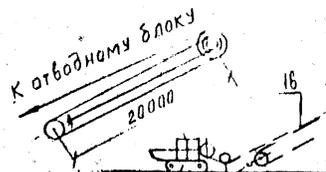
Схема подвеса опоры ПП 220-1/79
